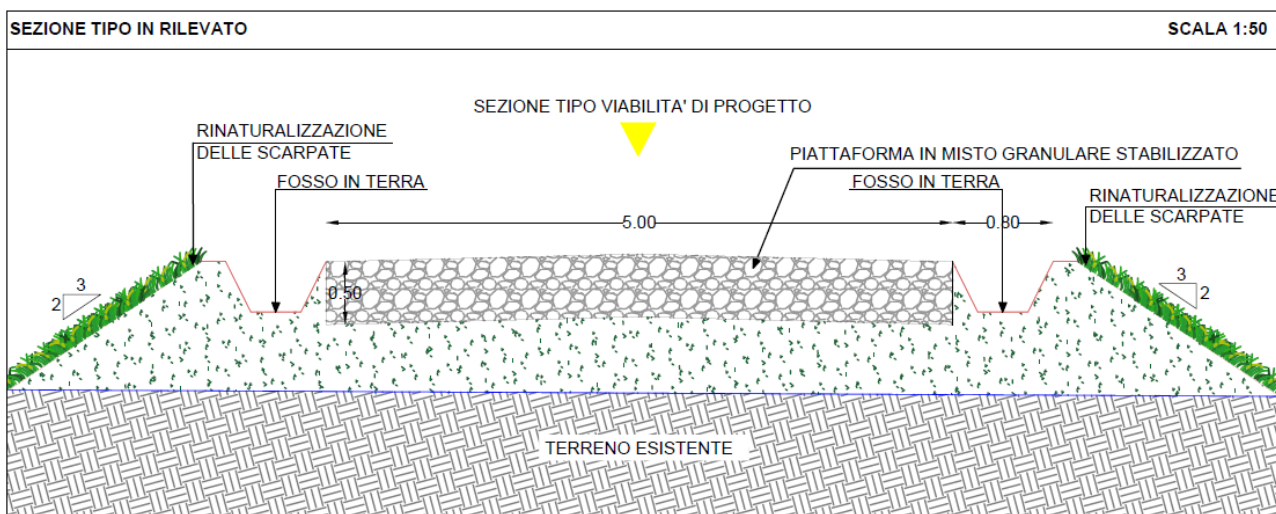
Sezione tipo in rilevato per la nuova viabilità
